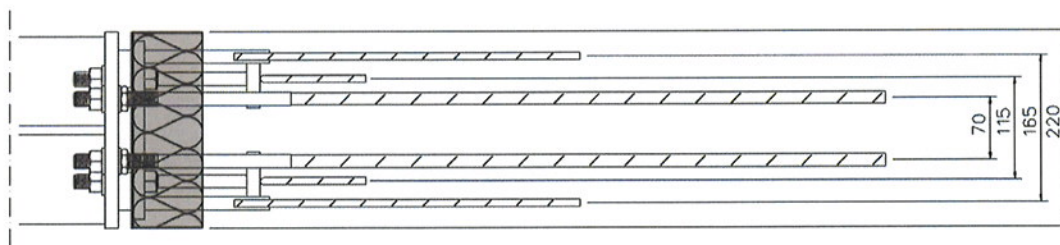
Grundriss Isopro Typ SBM14 Q8 und SBM14 Q10
